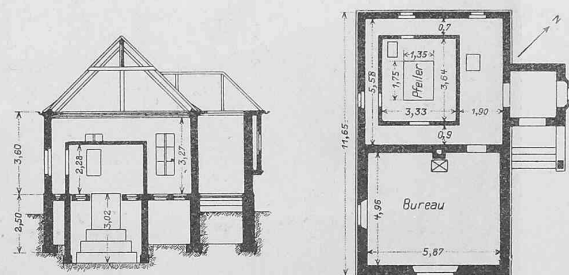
Grundriss und Querschnitt des Erdbebenhauses. — 1 : 300.
